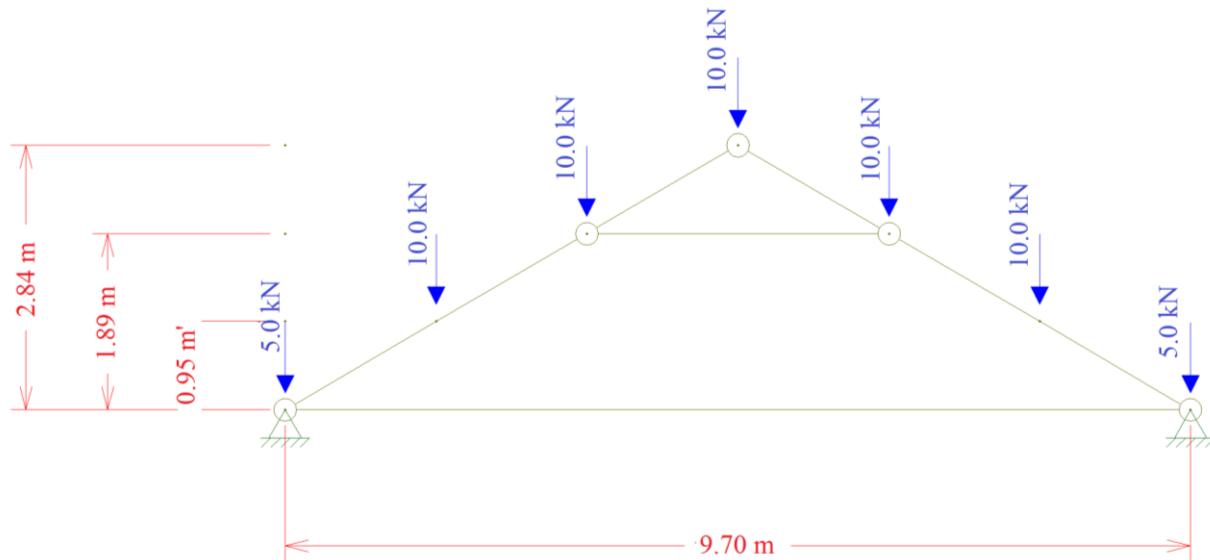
Esquema estrutural e carregamento da tesoura de linha baixa e alta da nave.
